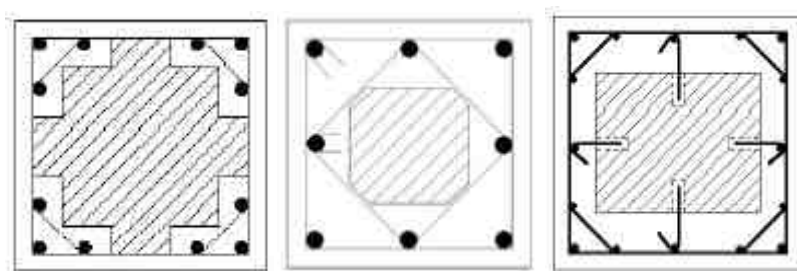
Tipuri de prindere a armaturilor longitudinale intermediare (P100-3/2008)
